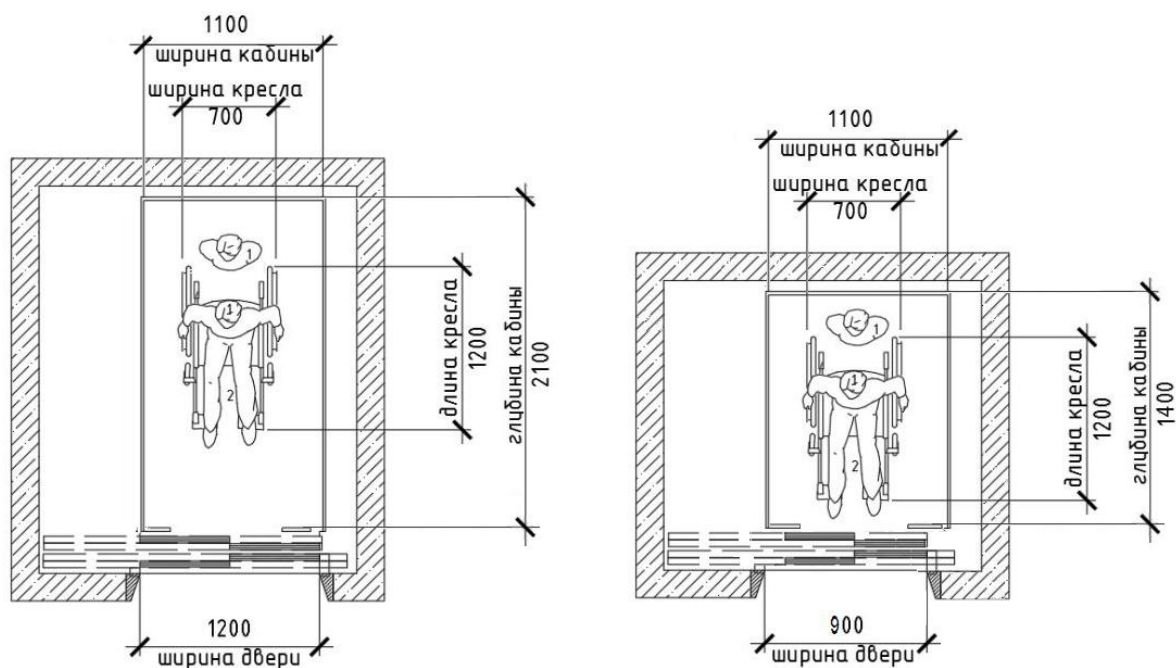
Размеры лифтов с креслом-коляской по ГОСТР50602
